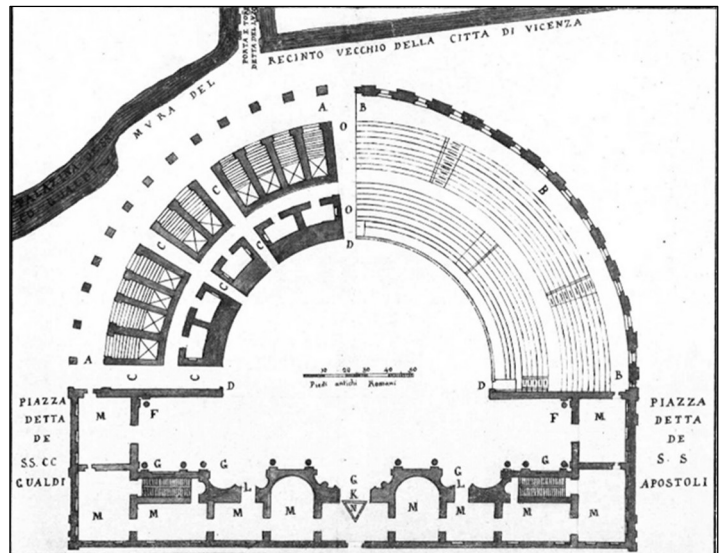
La pianta del teatro Berga di O. Zago. Fonte: MARCHINI 1979, fig. 3.
